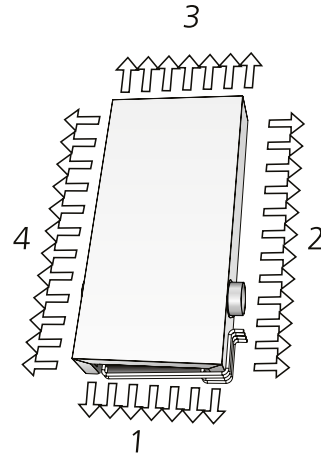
Draufsicht PARASOL EX 1290, Seite 1-4
